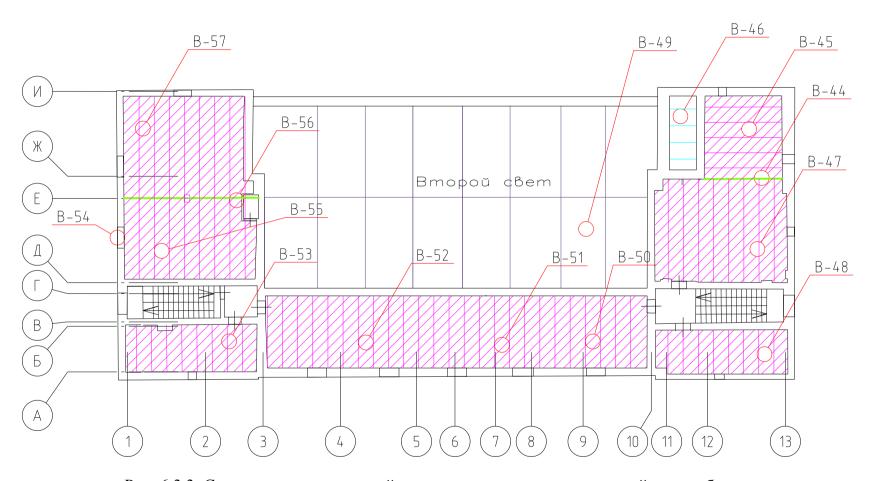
Схема участков вскрытий над третьим этажом с раскладкой плит и балок.
